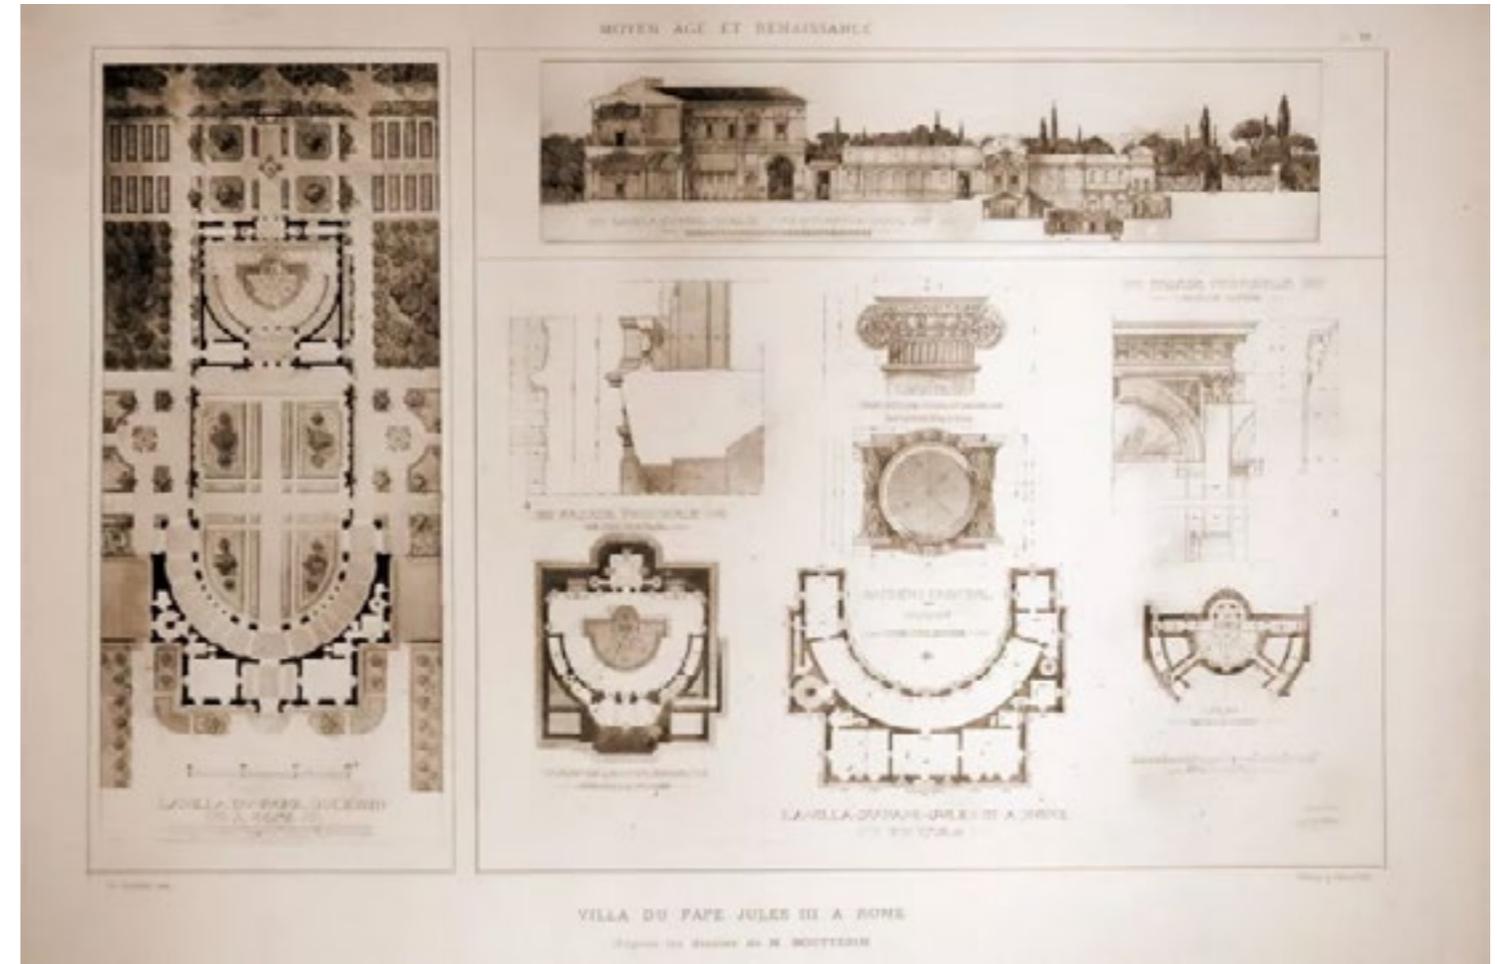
Planimetría de la obra renacentista - manierista Villa Giulia de Giacomo Barozzi da Vignola entre 1551 y 1553.
